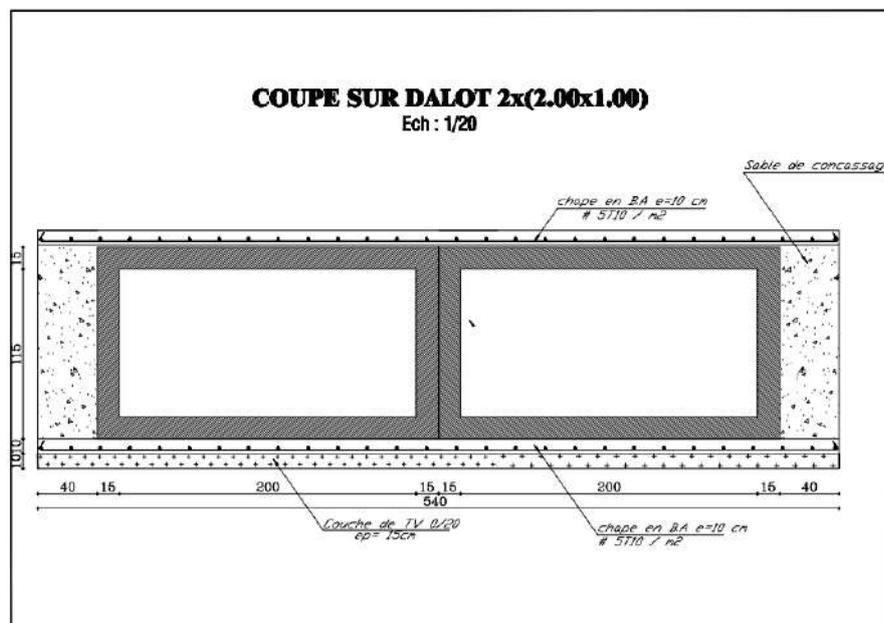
Coupe sur dalot 2 * (2 * 1).
